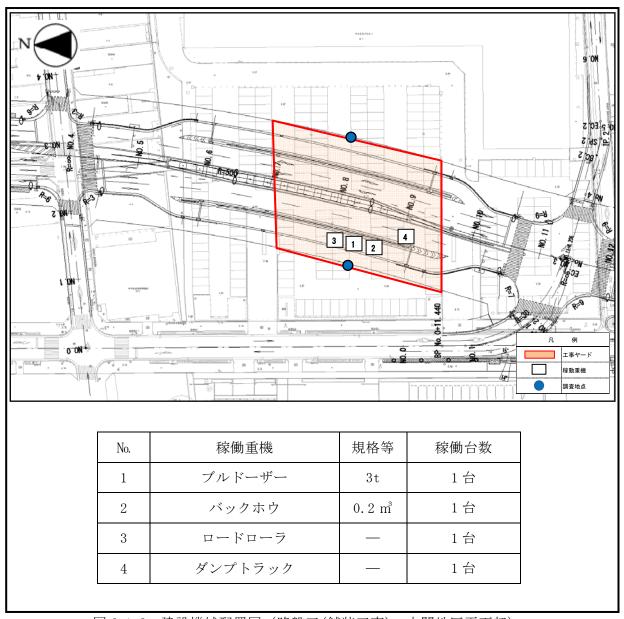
建設機械配置図 (路盤工(舗装工事):太閤地区平面部)
